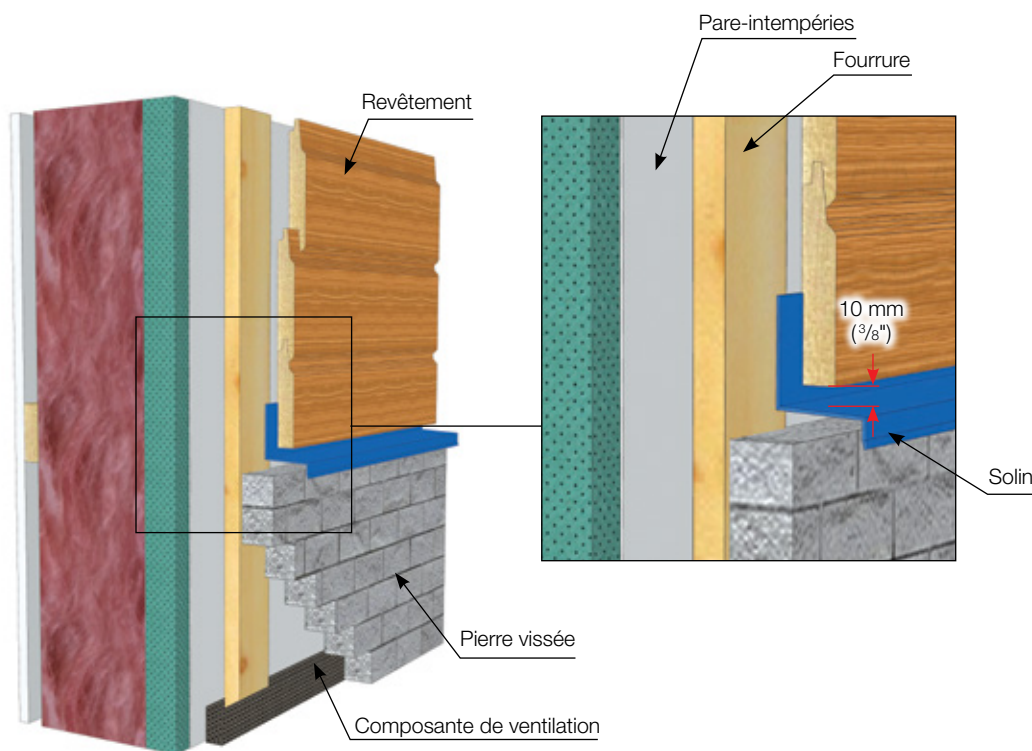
• Préparation des murs à la jonction d'un mur de pierres vissées (ou imitation de pierres)
